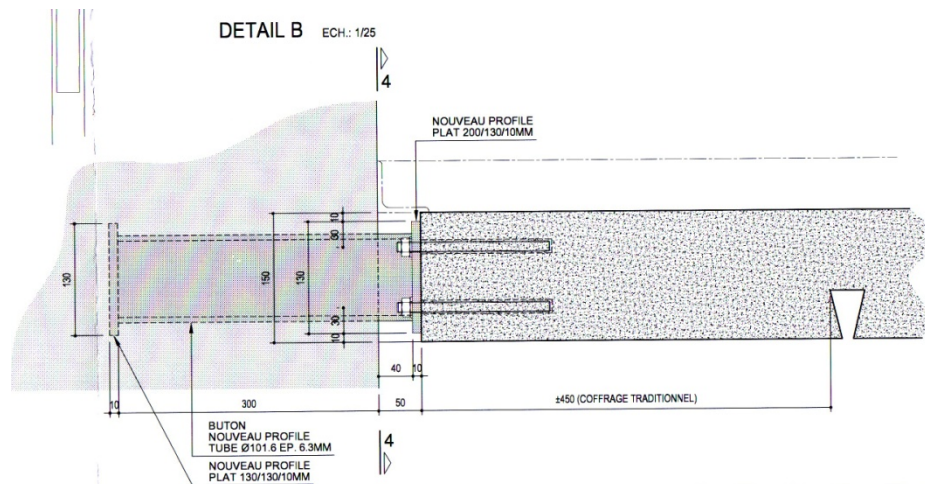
Détail de la connexion de la dalle de la galerie avec la dalle de l'escalier. (Plans-d'exécution, 2007)
